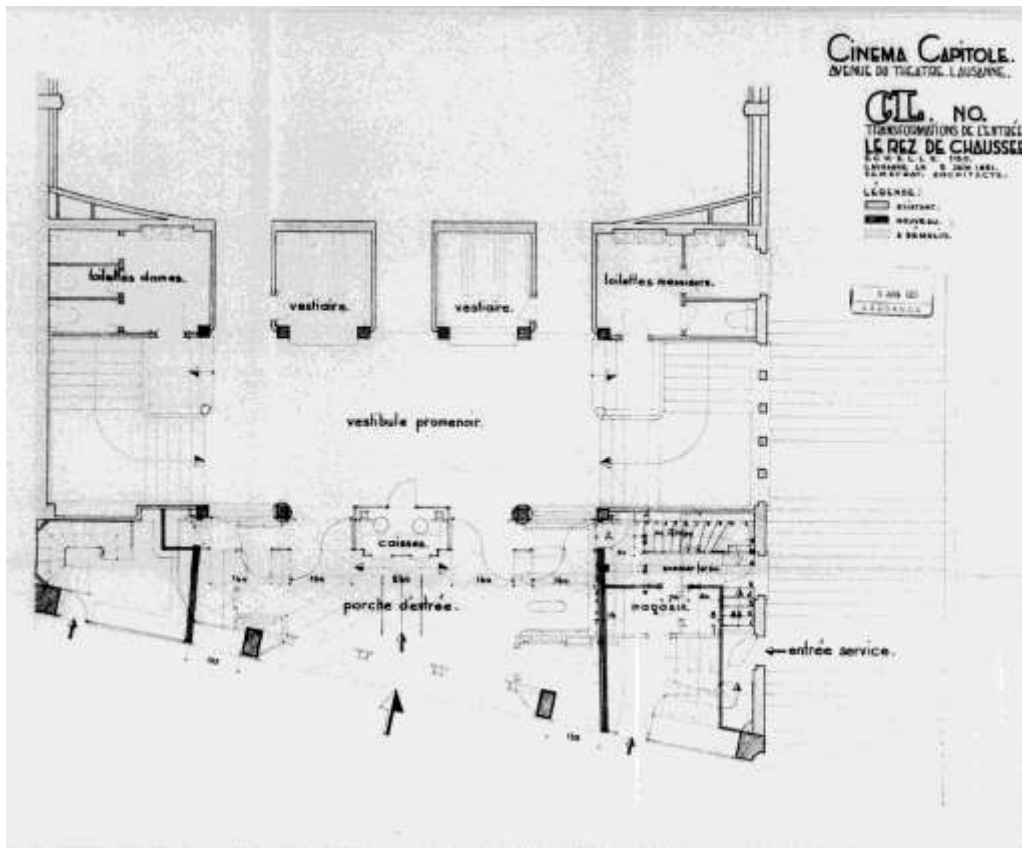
Plan du rez-de chaussée, Ferdinand Meyrat architecte, 5.6.1951 (AVL).
